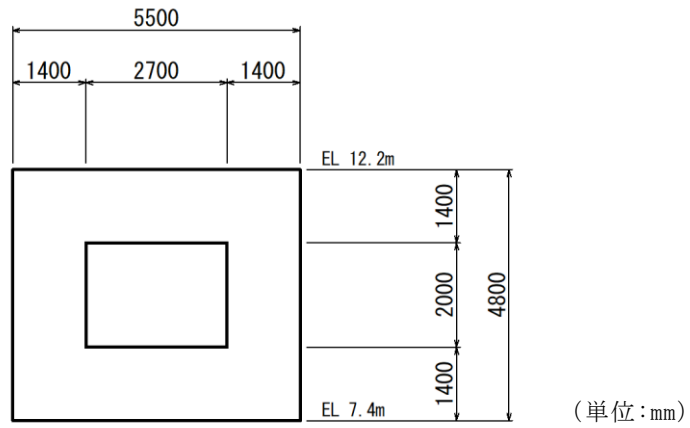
第 1 ベントフィルタ格納槽 断面図 (D-D 断面)
